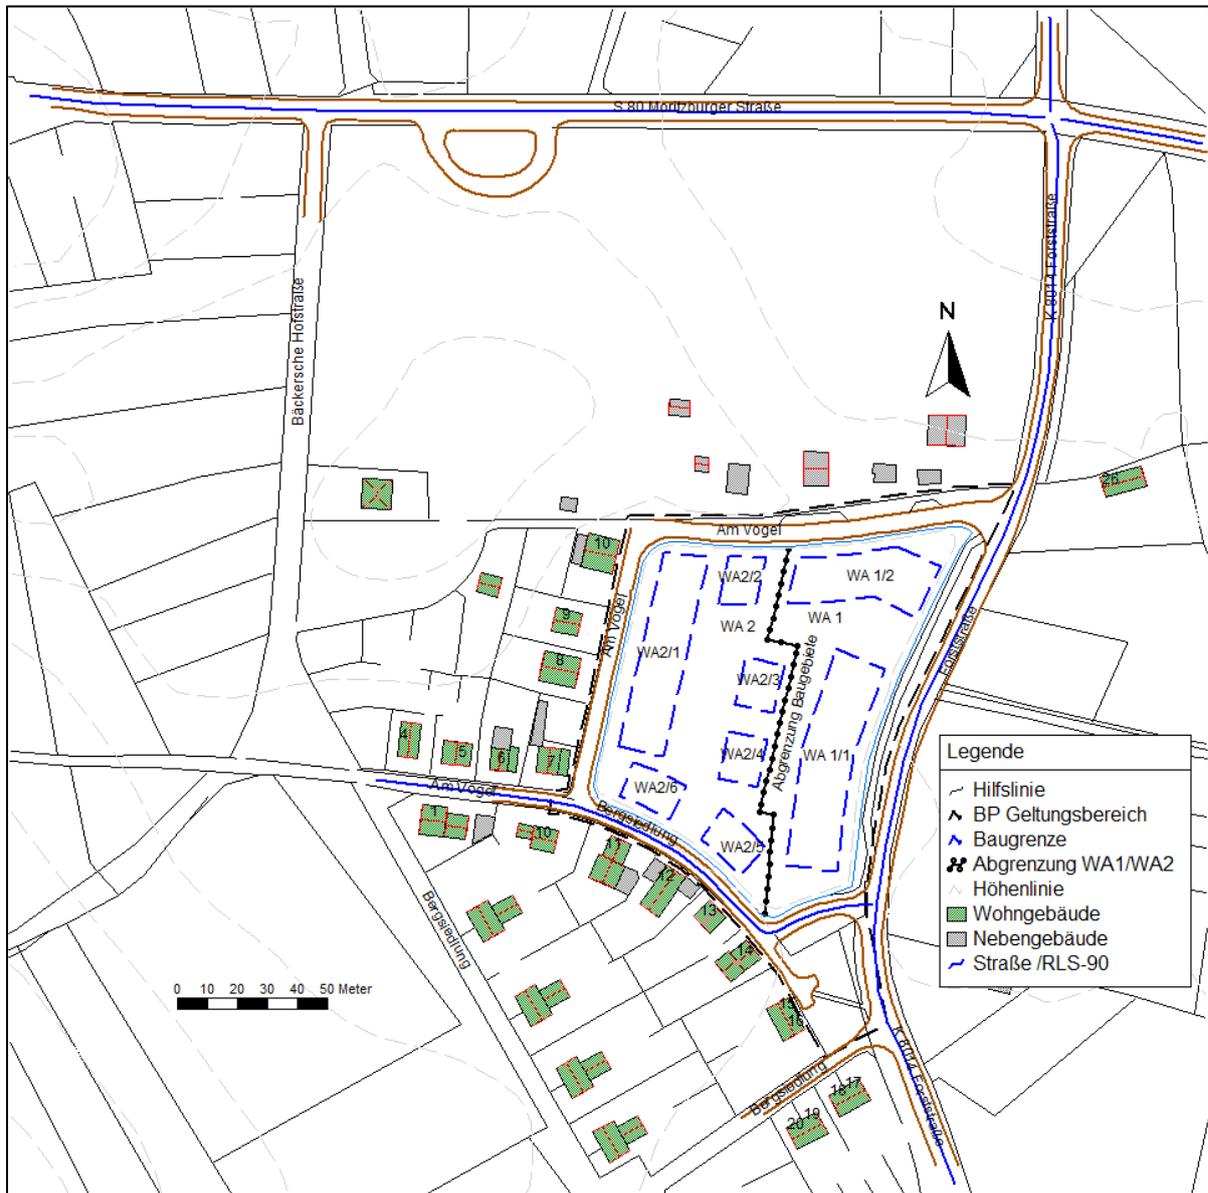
Lageplan (Rechenmodell) mit den maßgeblichen Straßenführungen, dem Areal des Bebauungsplanes Nr. 07/2018 und den Baugrenzen in den Baugebieten WA 1 und WA 2
